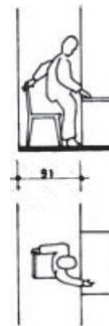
Ruang Gerak Minimum dalam Jangkauan Ruang Baca
